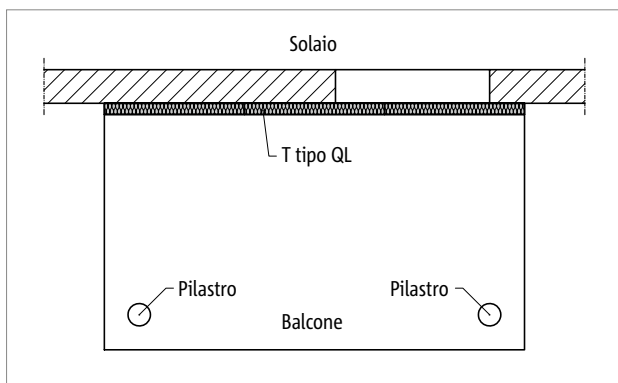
Schöck Isokorb® T tipo QL: balcone con appoggio su pilastri
